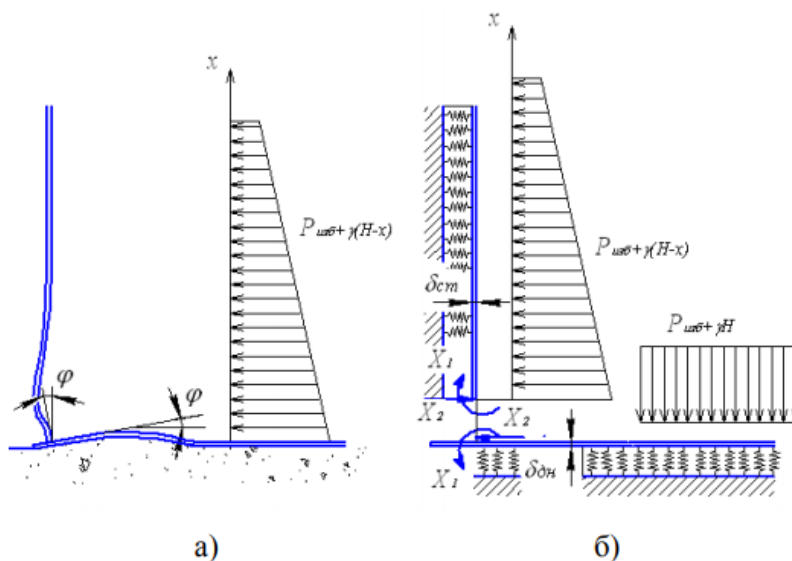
Расчетная схема приложения нагрузок для узла сопряжения стенки резервуара и днища, решаемая методом сил
